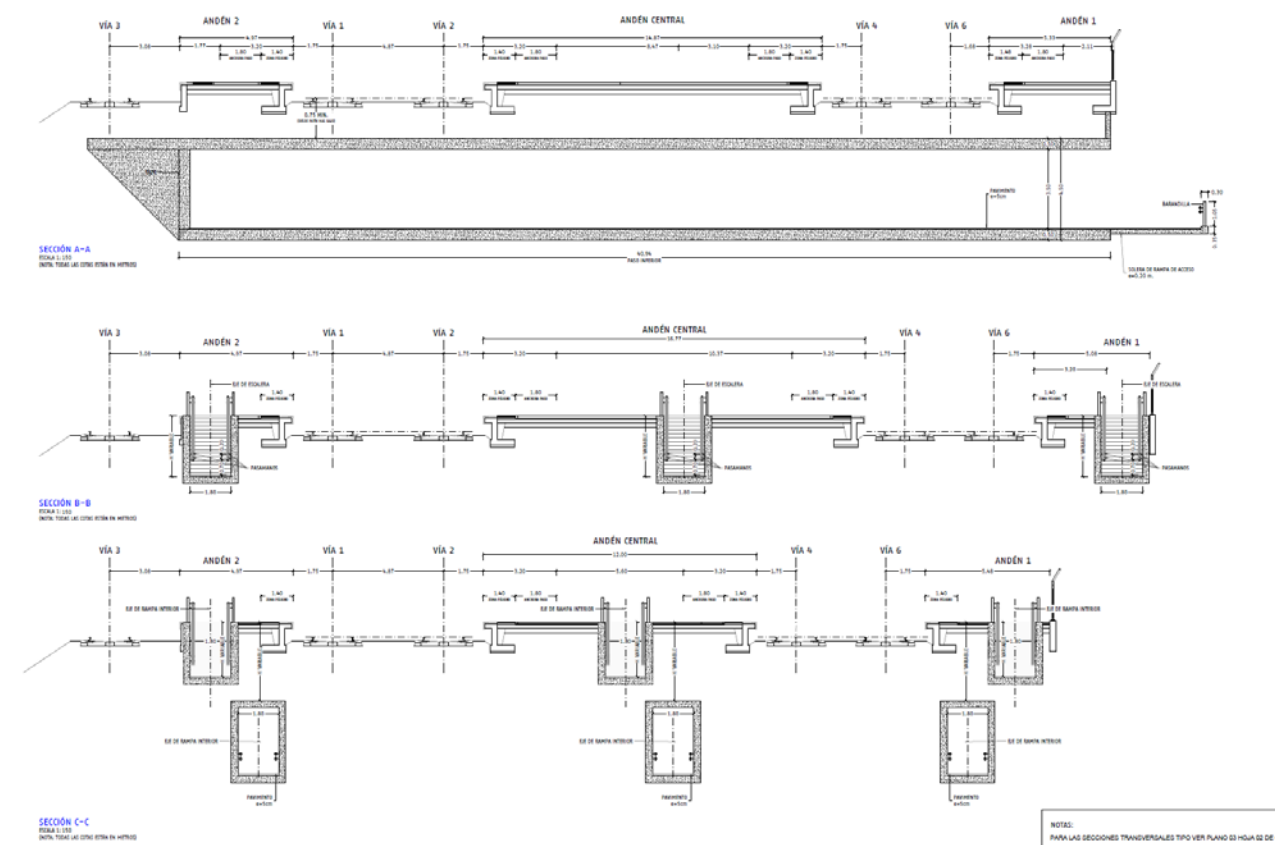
Secciones tipo de la alternativa a desarrollar en el Proyecto Constructivo
